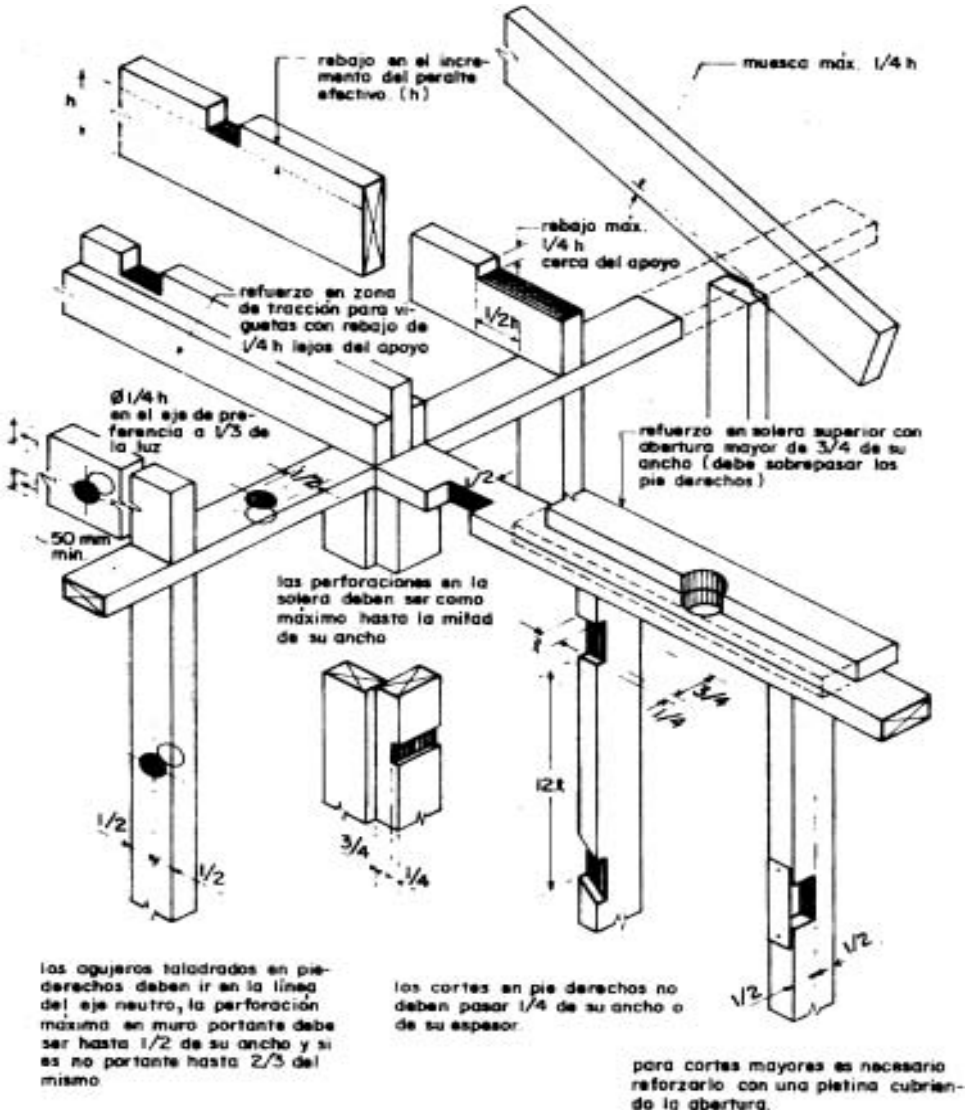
Perforaciones y rebajos en elementos de madera.
